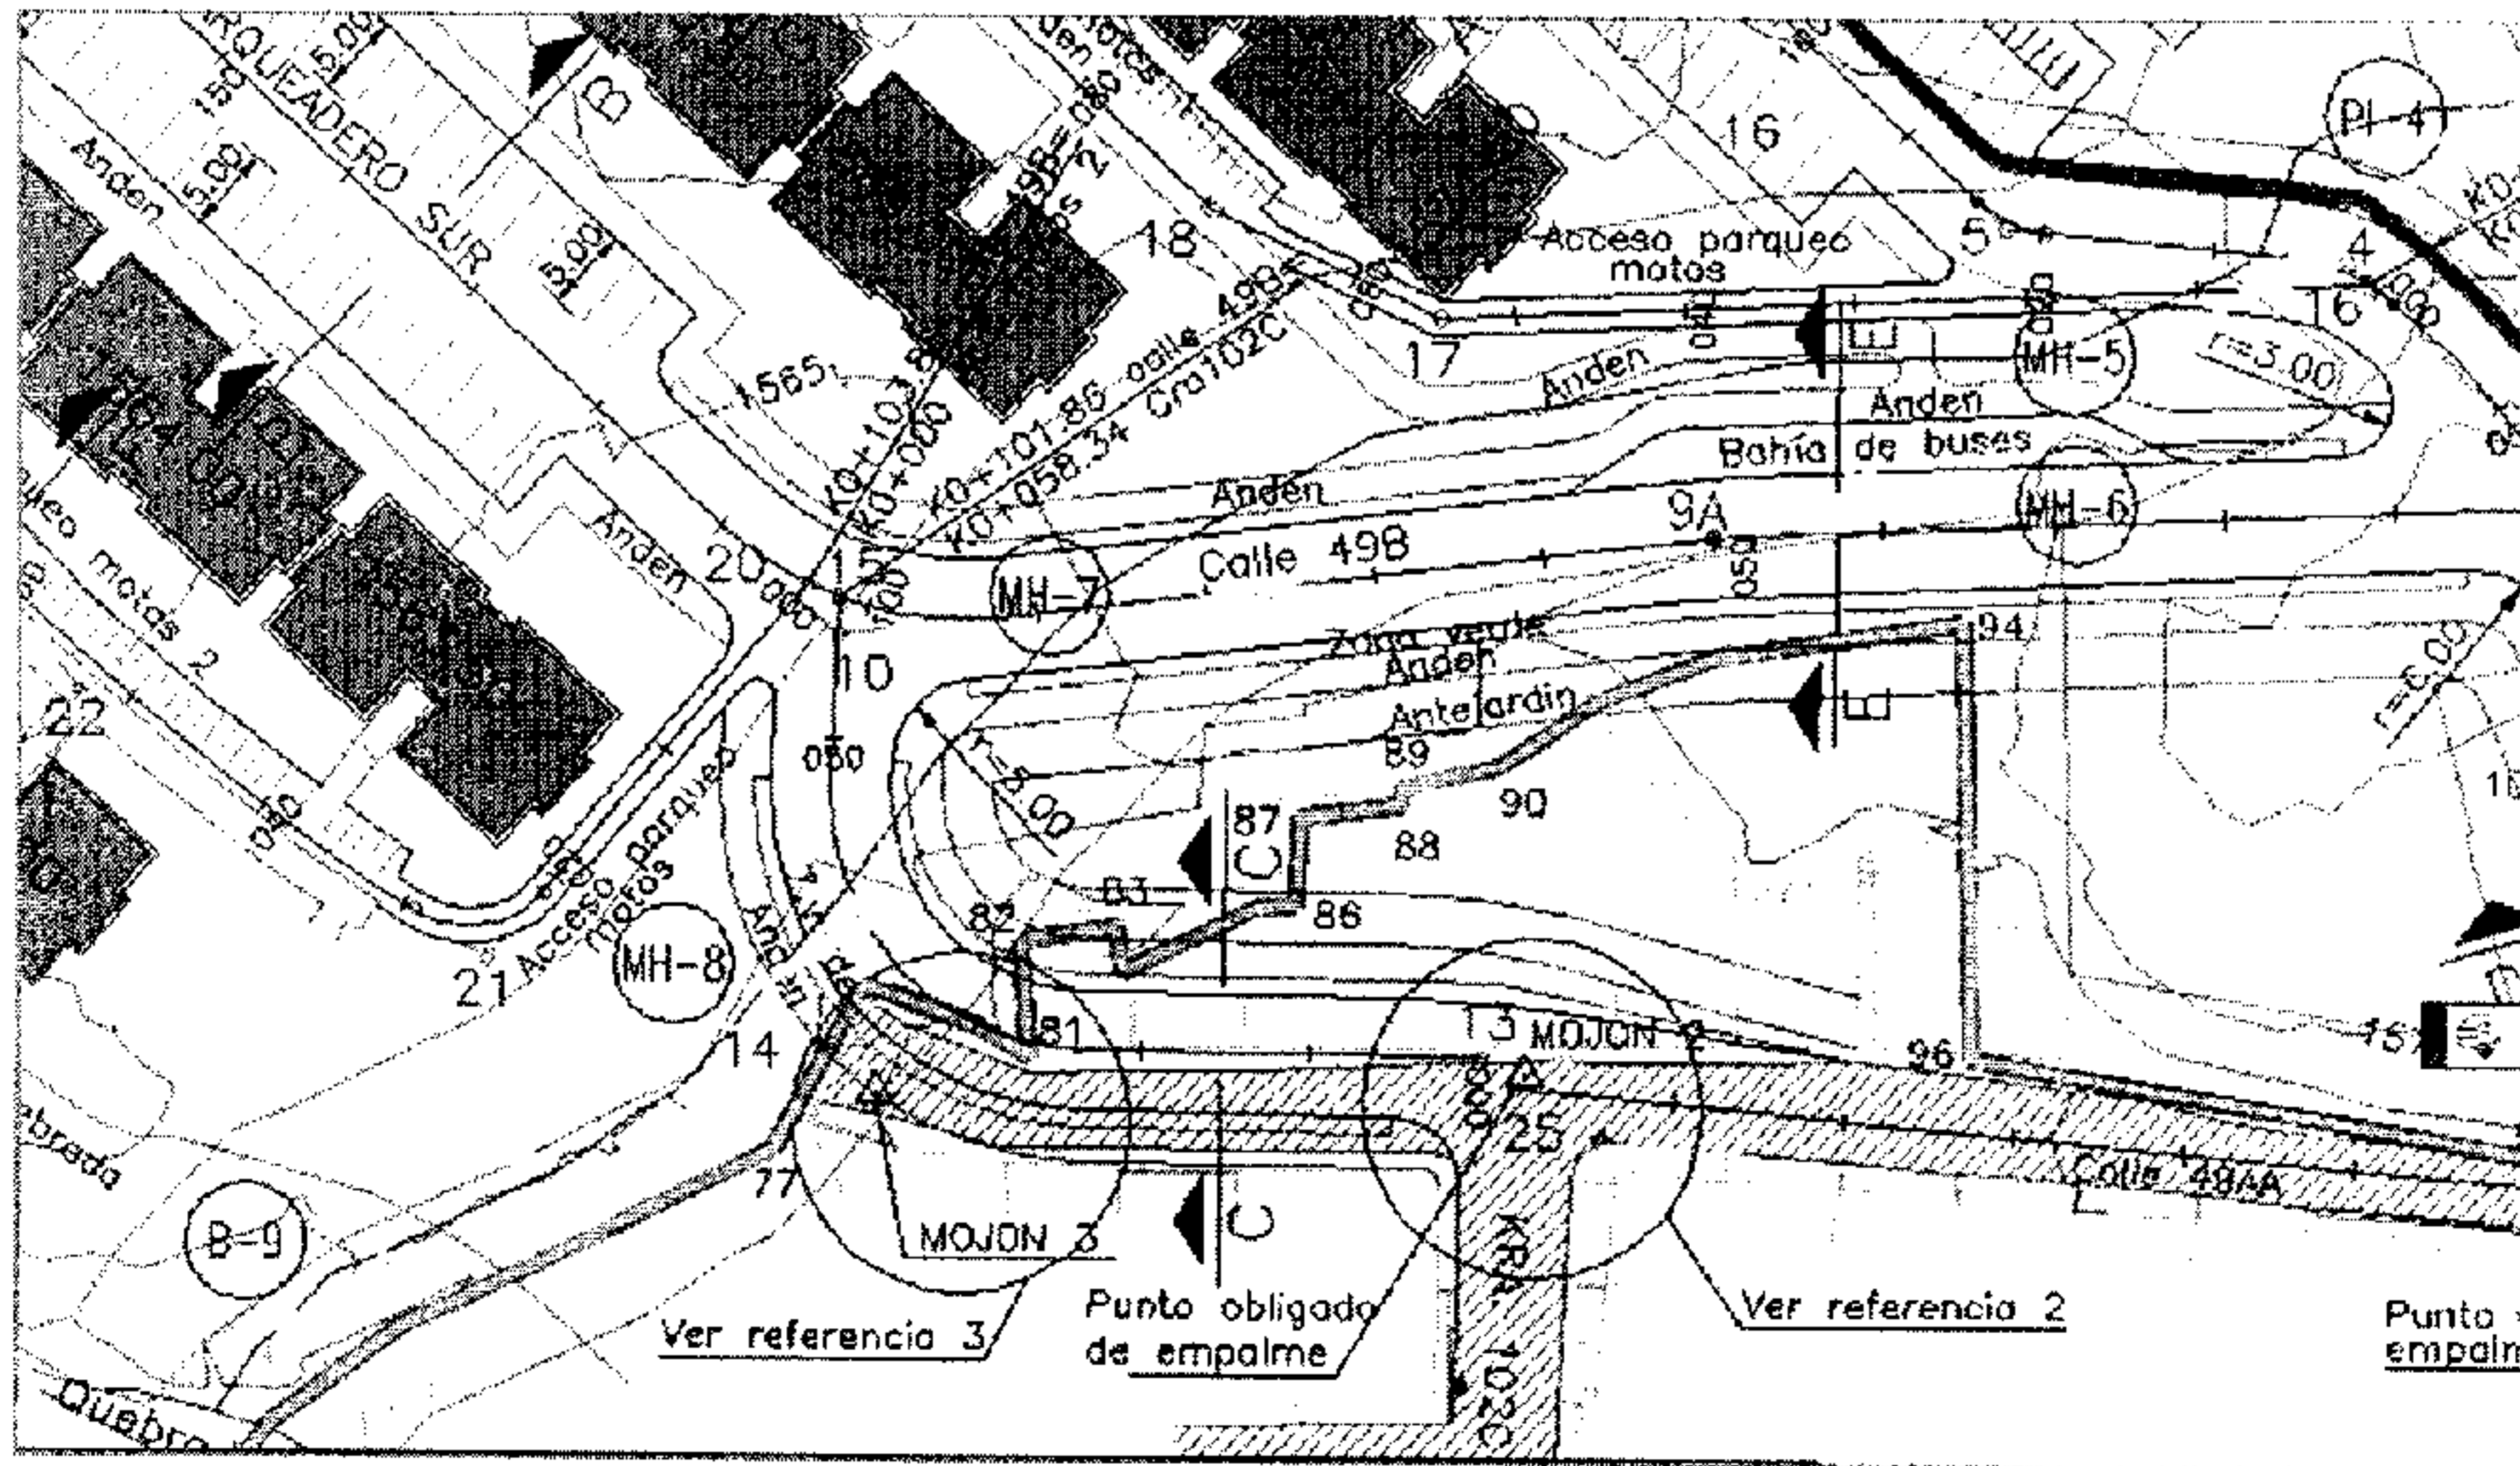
Planta tramo conducción caño La Cabaña (fuente. Informe anexo al radicado 001526 de 24-01-2014)
